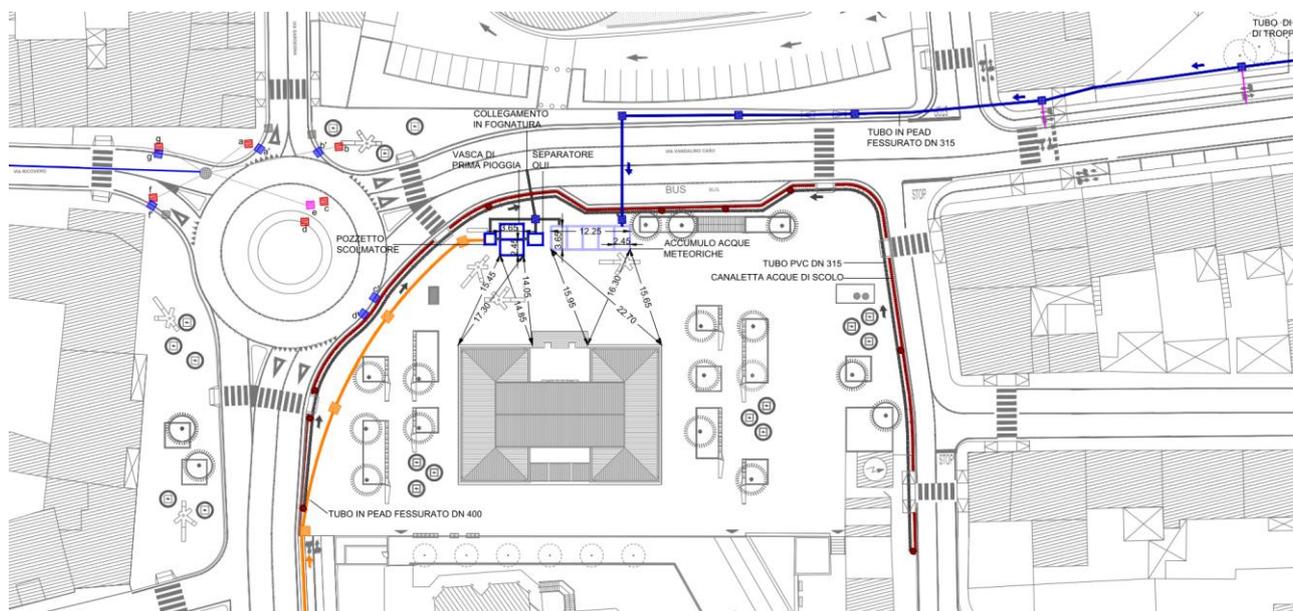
Stralcio planimetria smaltimento acque meteoriche, Progetto riqualificazione ex Foro Boario.
